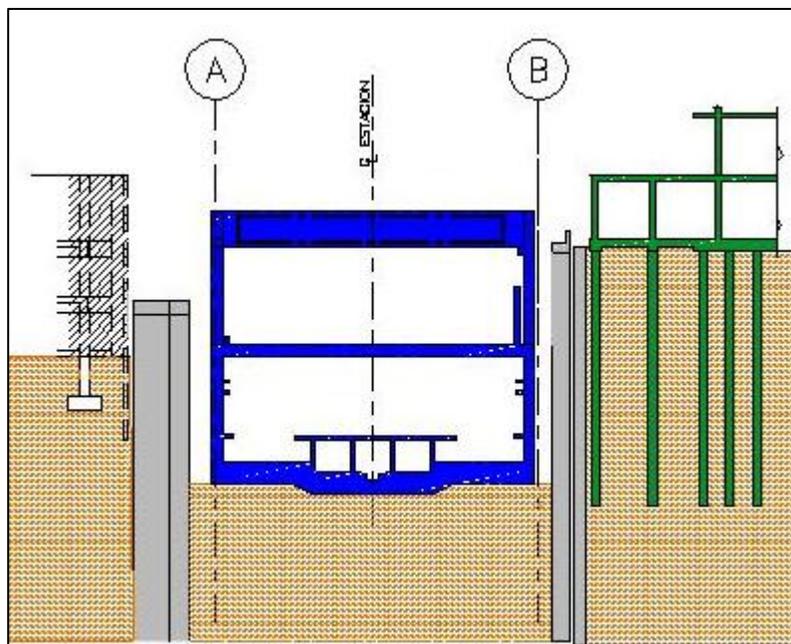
Corte de segunda fase de muros colados y apuntalamiento.
